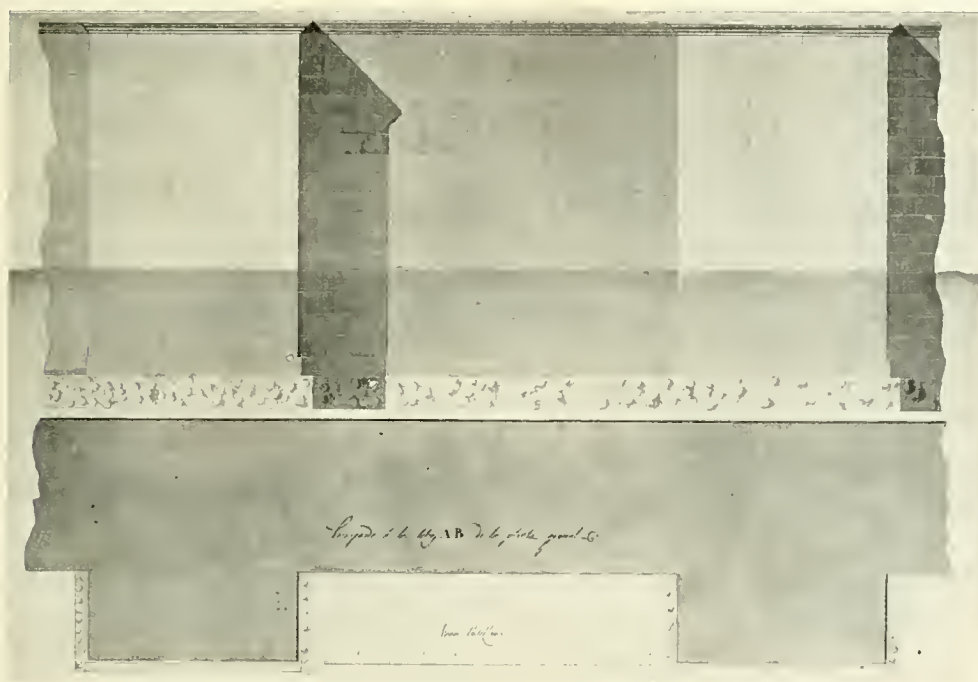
Planta y alçat de la Muralla romana de Barcelona qu'existí en el carrer de Basea. A B de la planta general. Dibuix de'n Celles (Arxín de la Junta de Comerç)
